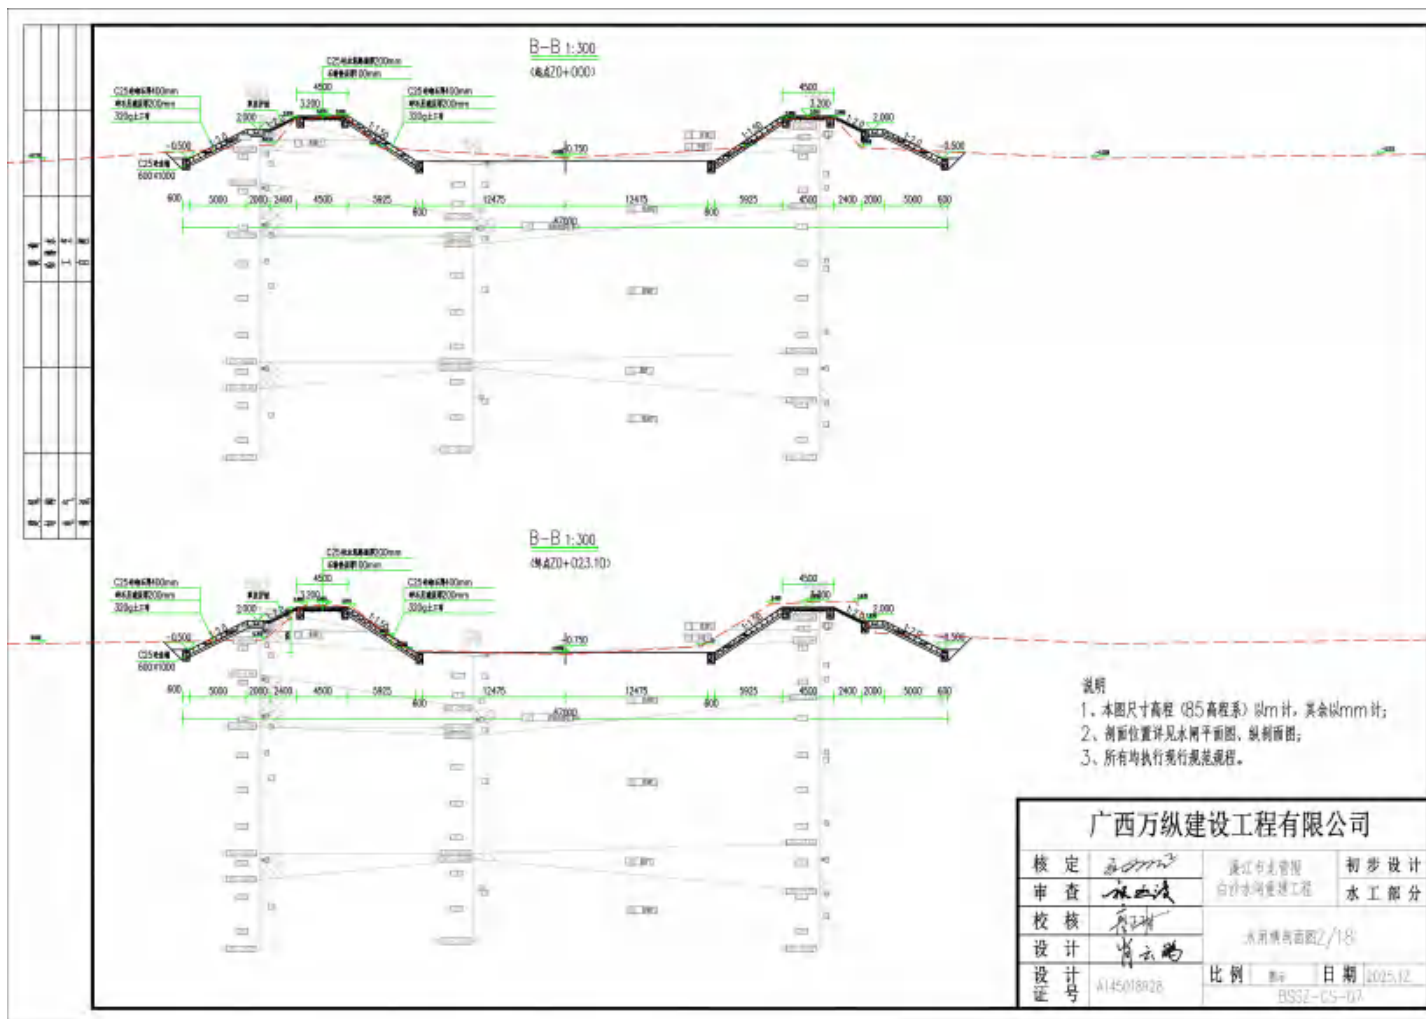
水闸横剖面图 (内涌引堤段)
